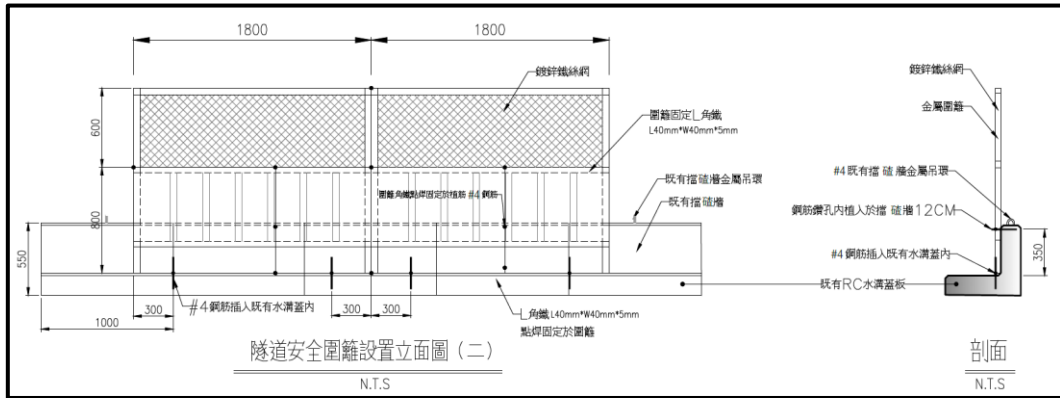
鳳林隧道施工圍籬施工圖面
